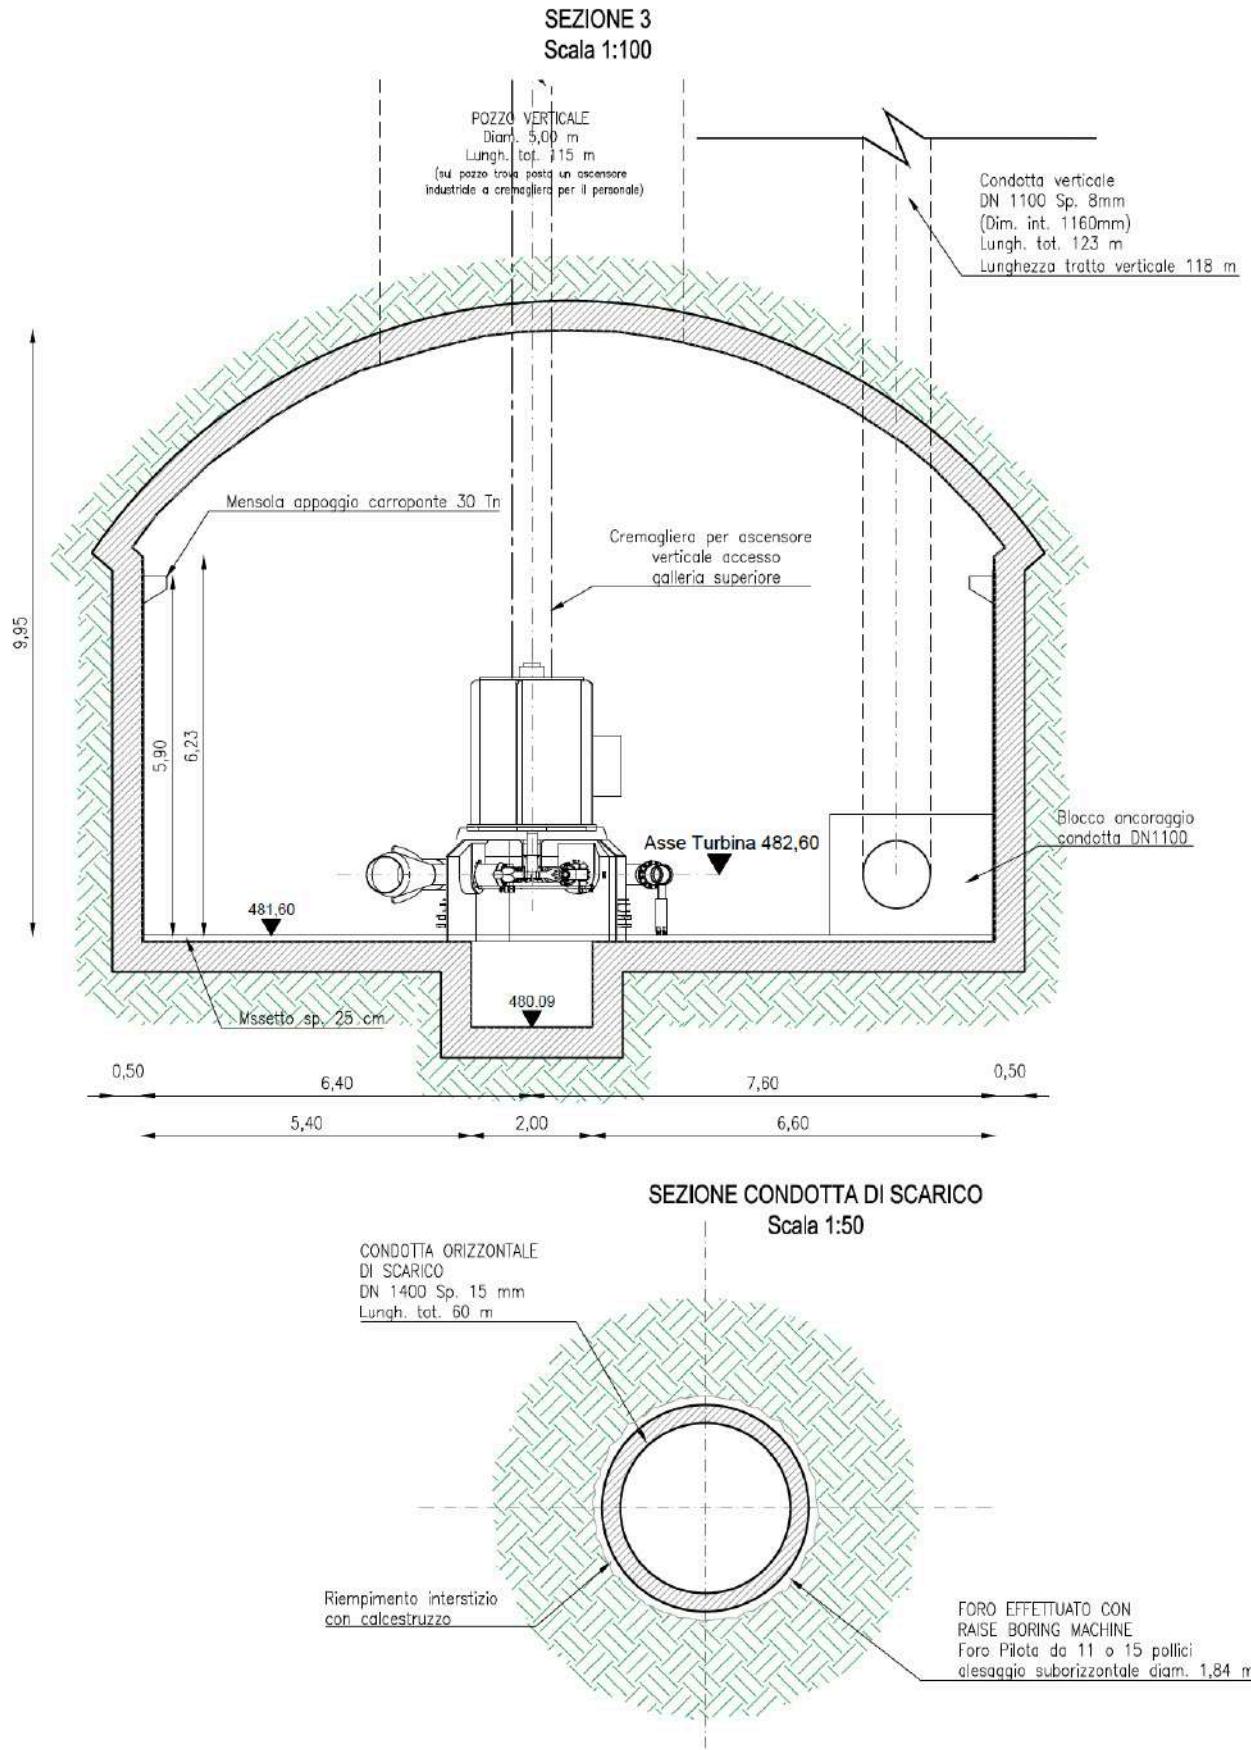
Sezione della centrale e sezione della condotta di scarico.
